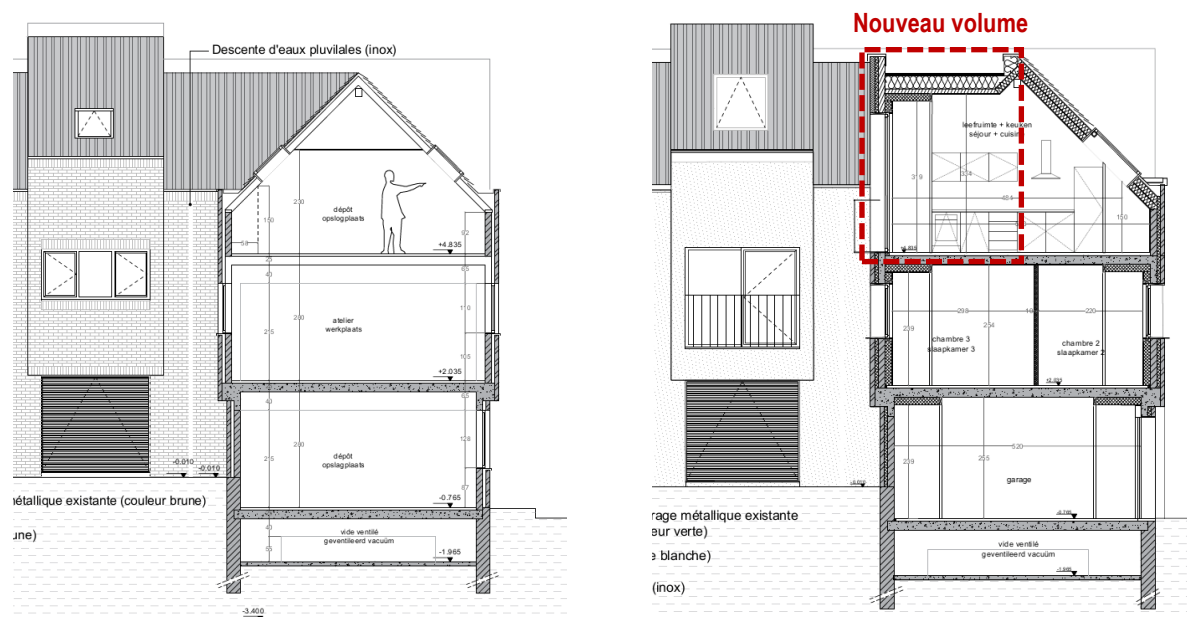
Coupe transversale du bâtiment bordant la rue aux Fleurs : situation existante (à gauche) vs. situation projetée (à droite) (Ville de Bruxelles, 2025)
